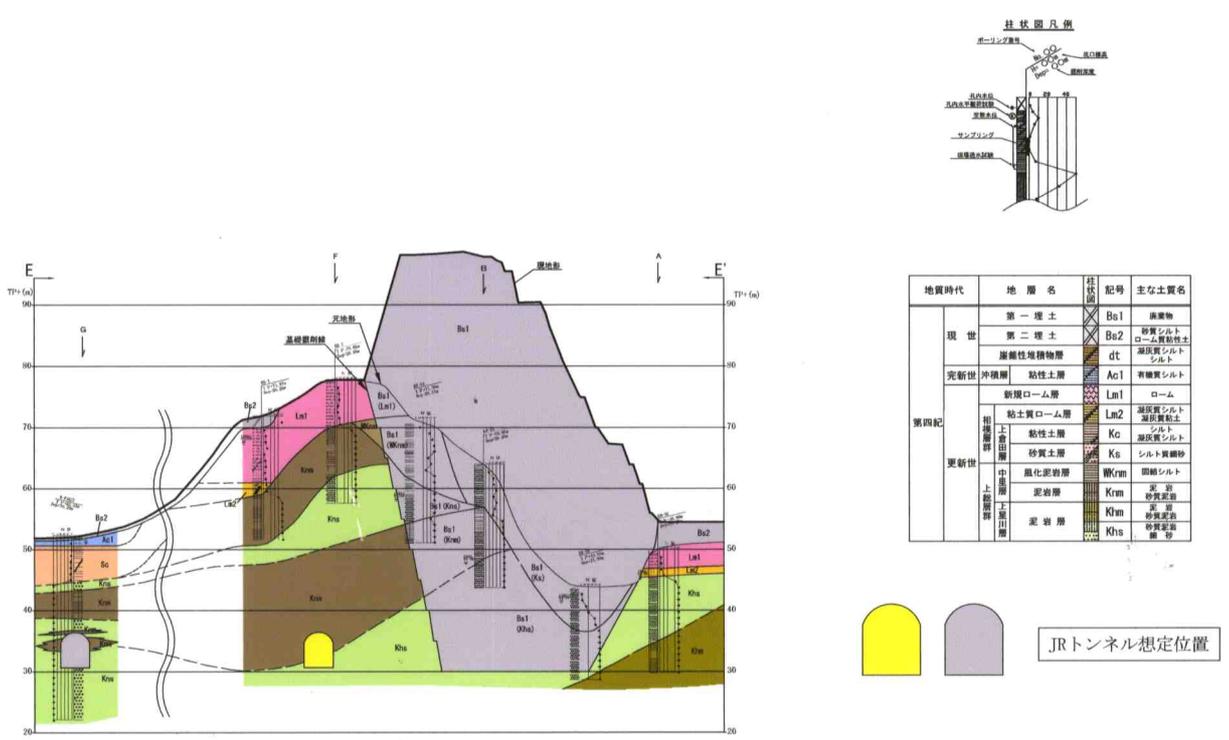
地質推定断面図 (E-E' 断面 SH=1:2,000 SV=1:600)
